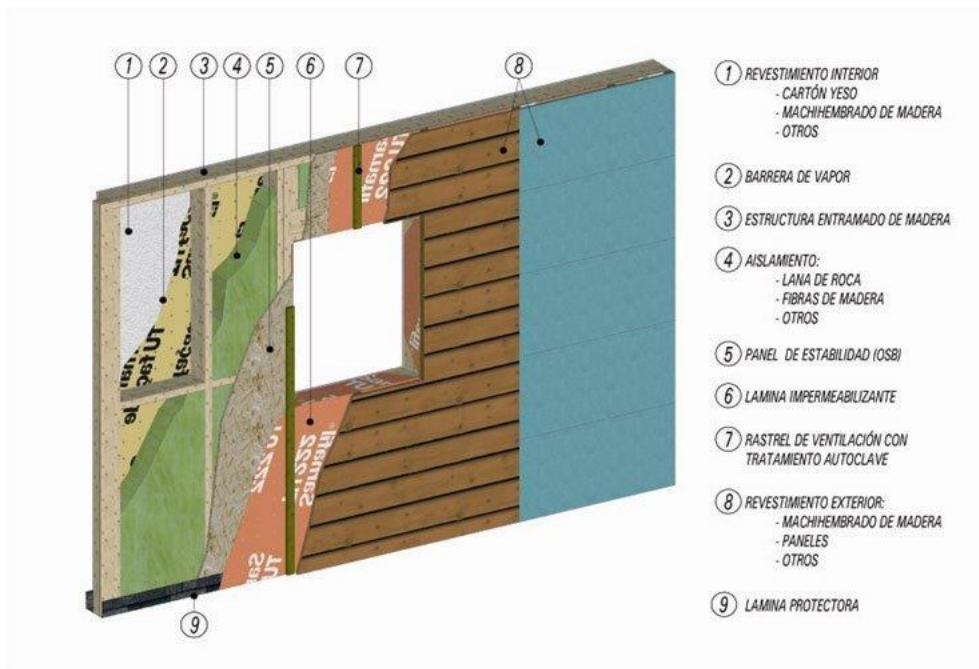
Pared típica de entramado ligero de madera. Fuente: Empresa Maderas Casais.
